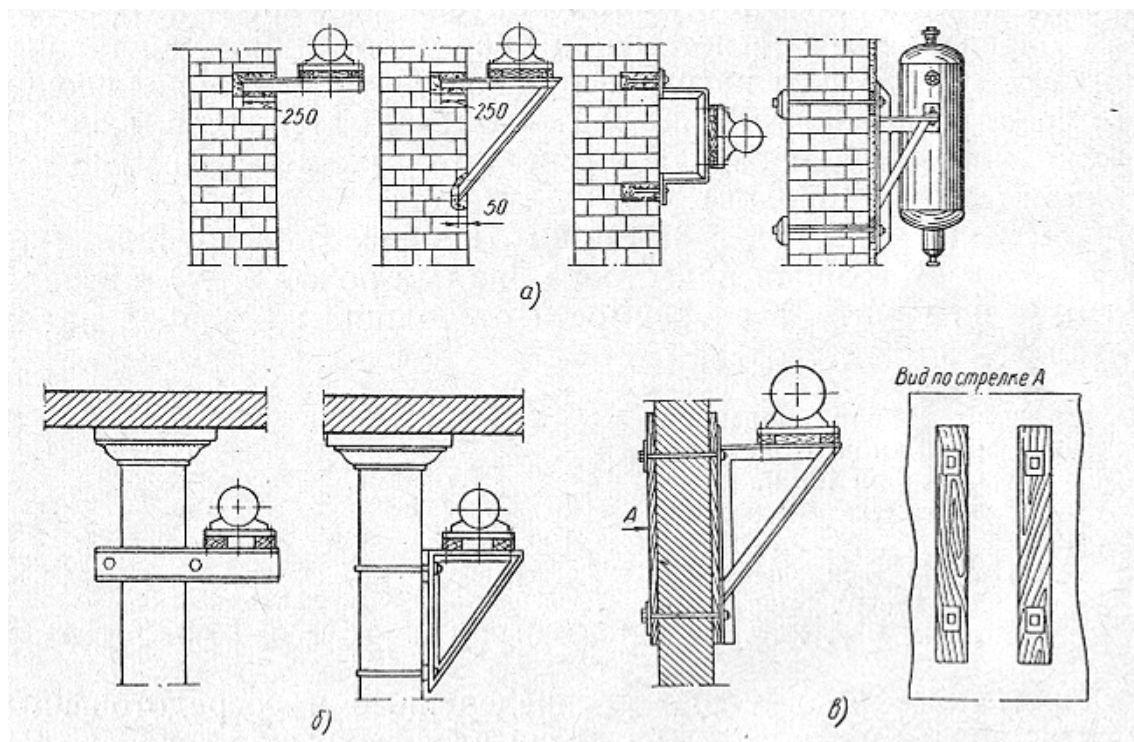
Крепление оборудования к стенам и колоннам зданий:
